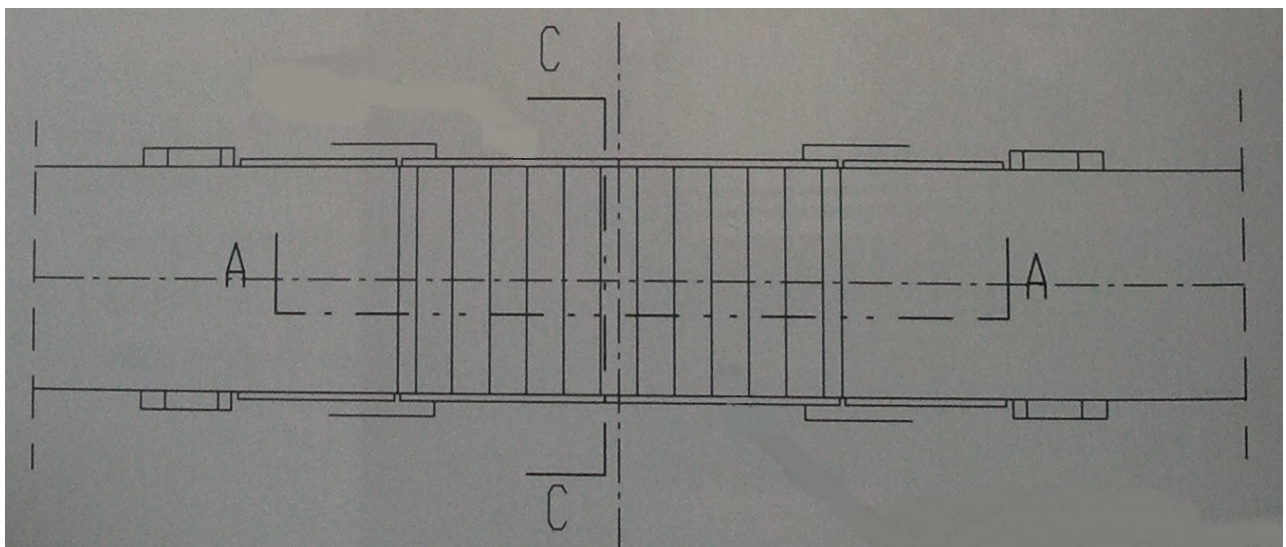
Planta de uma ponte pedonal (Schwaner, 2004)
